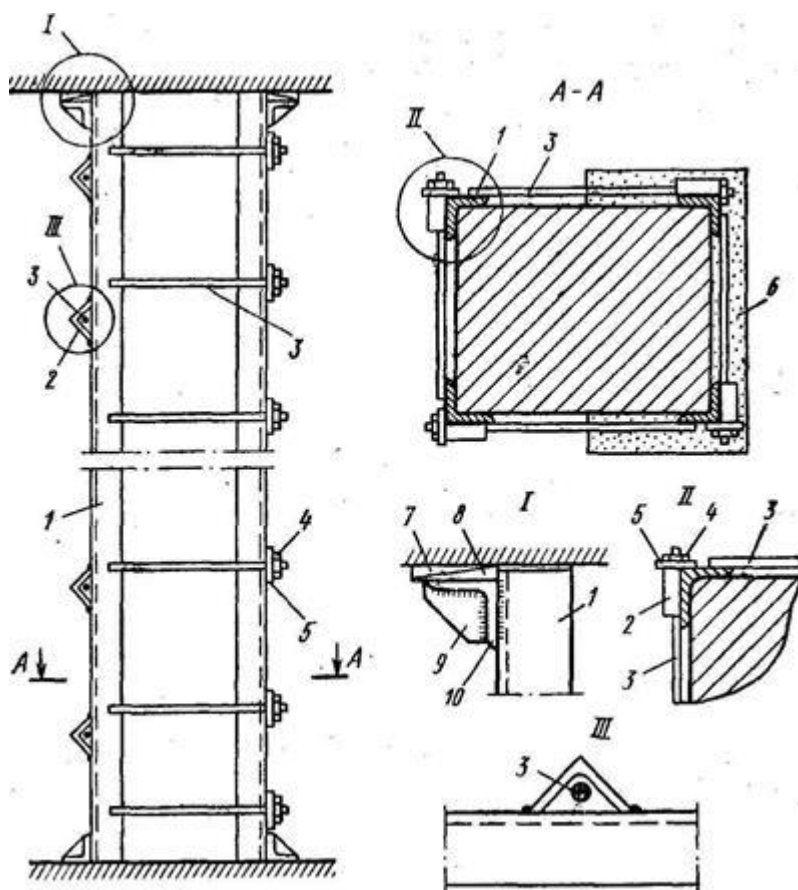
Усиление каменных столбов металлическими напрягаемыми обоймами: 1 - уголки; 2 - отрезок уголка; 3 - поперечный стержень; 4 - гайка; 5 - шайба; 6 - штукатурный слой; 7 - прямой клин; 8 - обратный клин; 9 - ребро жесткости; 10 - опорный уголок
